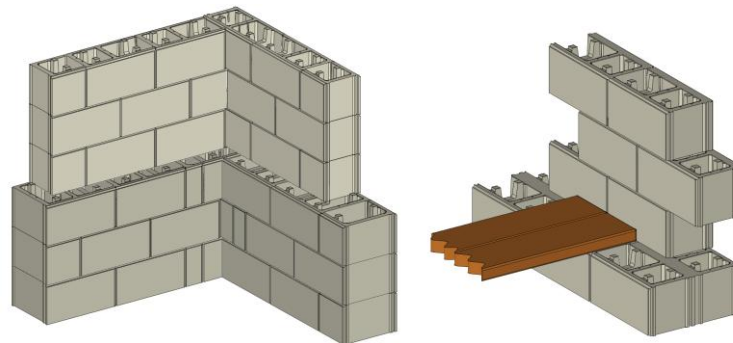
Apoio dos Pavimentos nas paredes de blocos de encaixe da Haener Block
